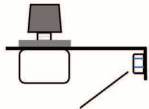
PLAN POUR UN PLAFOND FINI ET GRILLAGE
